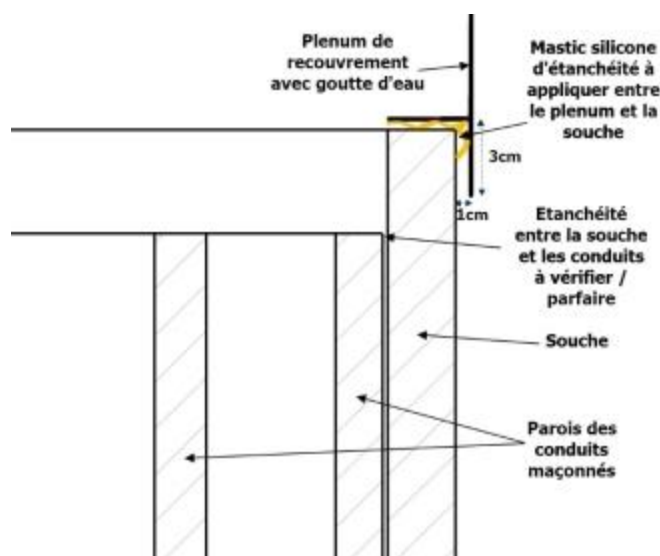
Coupe verticale d'un plenum de recouvrement sur souche avec dalle retirée
